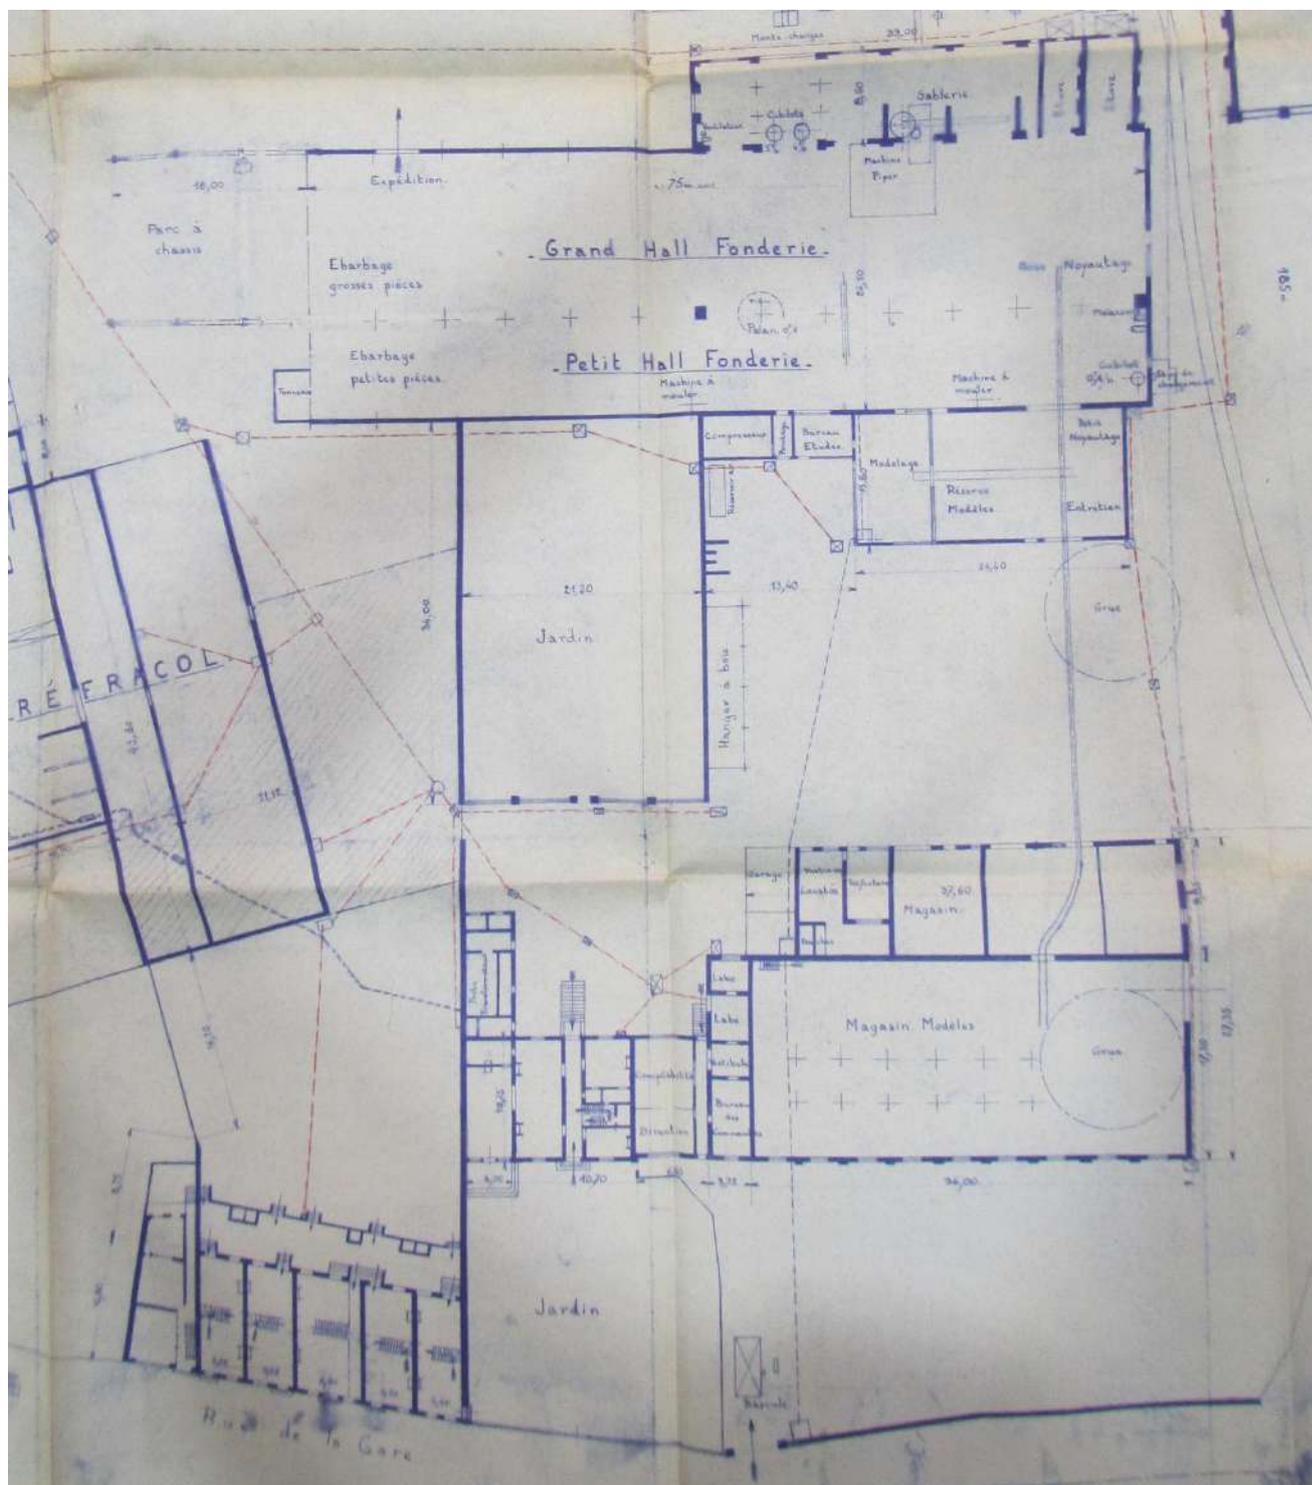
Plan masse de la fonderie de Marly (anc. REBOURG & DUPONT)
